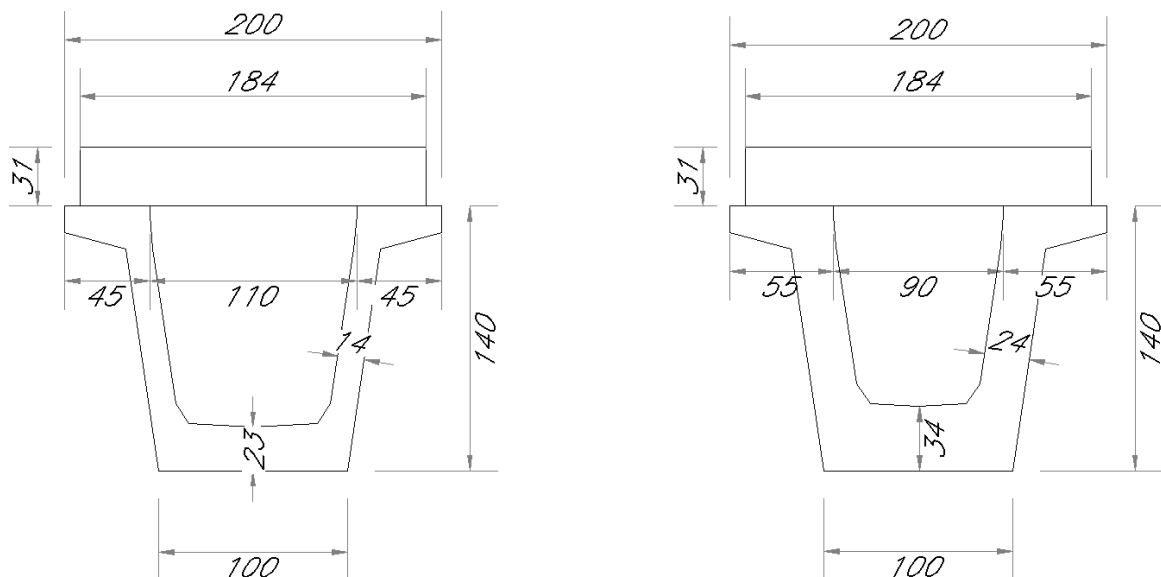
Sezioni in Fase 2 (cassoncino con soletta omogeneizzata a b.t.): sezione corrente e sezione di transizione - sezione di testata
